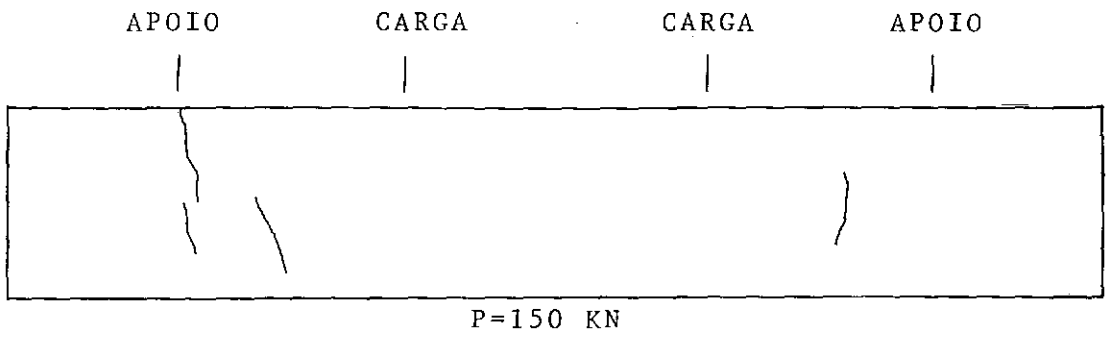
Fissuração da mesa da V14-3,70-SI
